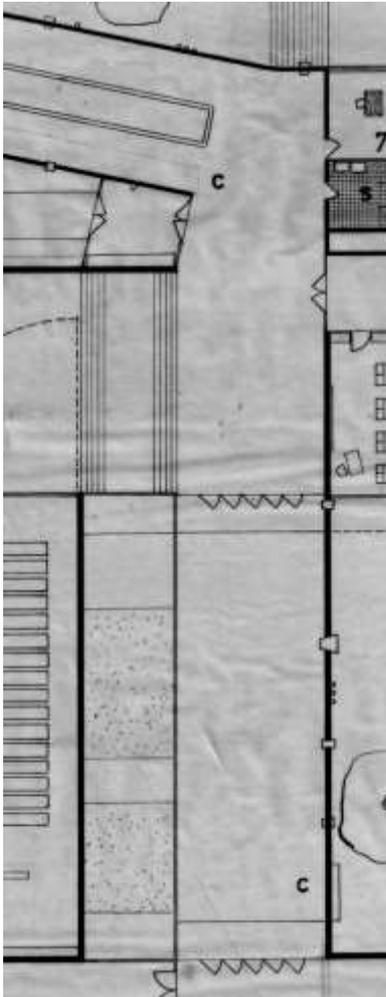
/ Detalle Planta PB lám. 16.853 DDI-IH
